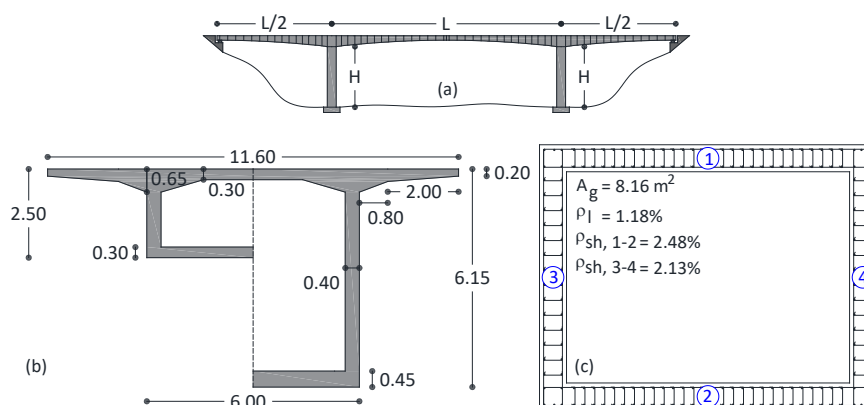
a) Geometría del puente, y b) sección transversal de las columnas
